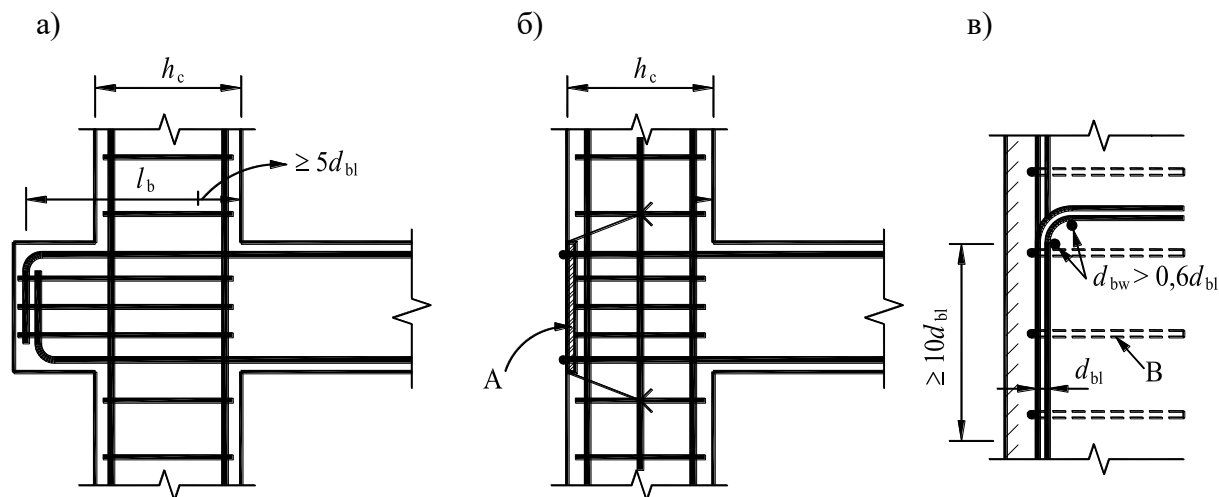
Дополнительные мероприятия для анкеровки продольной арматуры во внешних соединениях балка-колонна
